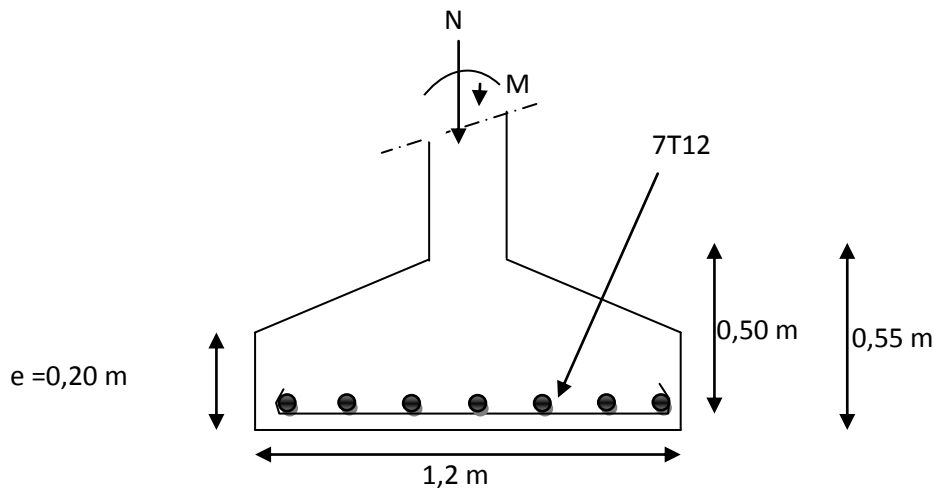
Ferrailage de la semelle centrale et intermédiaire
